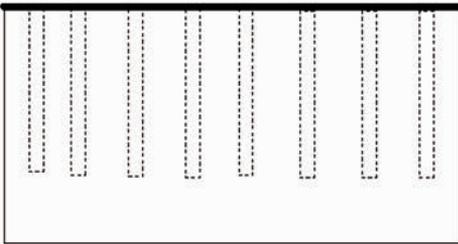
Detalle de la disposición geométrica de barrenos con una profundidad de al menos $\frac{3}{4}$ de la profundidad del elemento de hormigón a fracturar.
